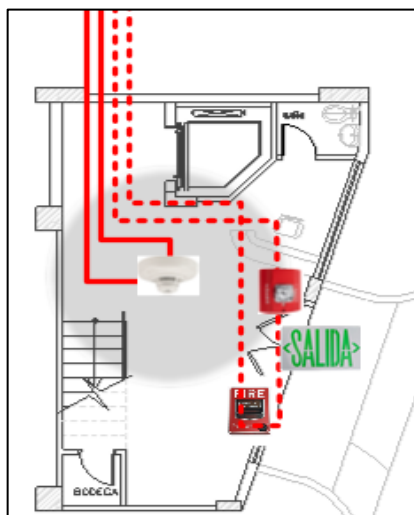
Ubicación de equipos para detección de incendios en planta baja
